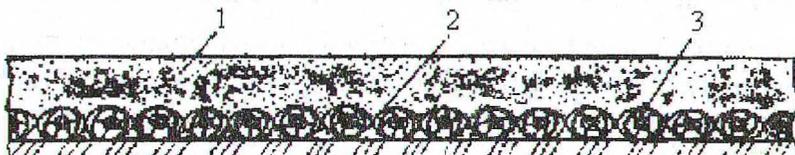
Конструкция деревогрунтового покрытия: 1 – дренарующий грунт; 2 – гибкая нить; 3 – поперечный настил
